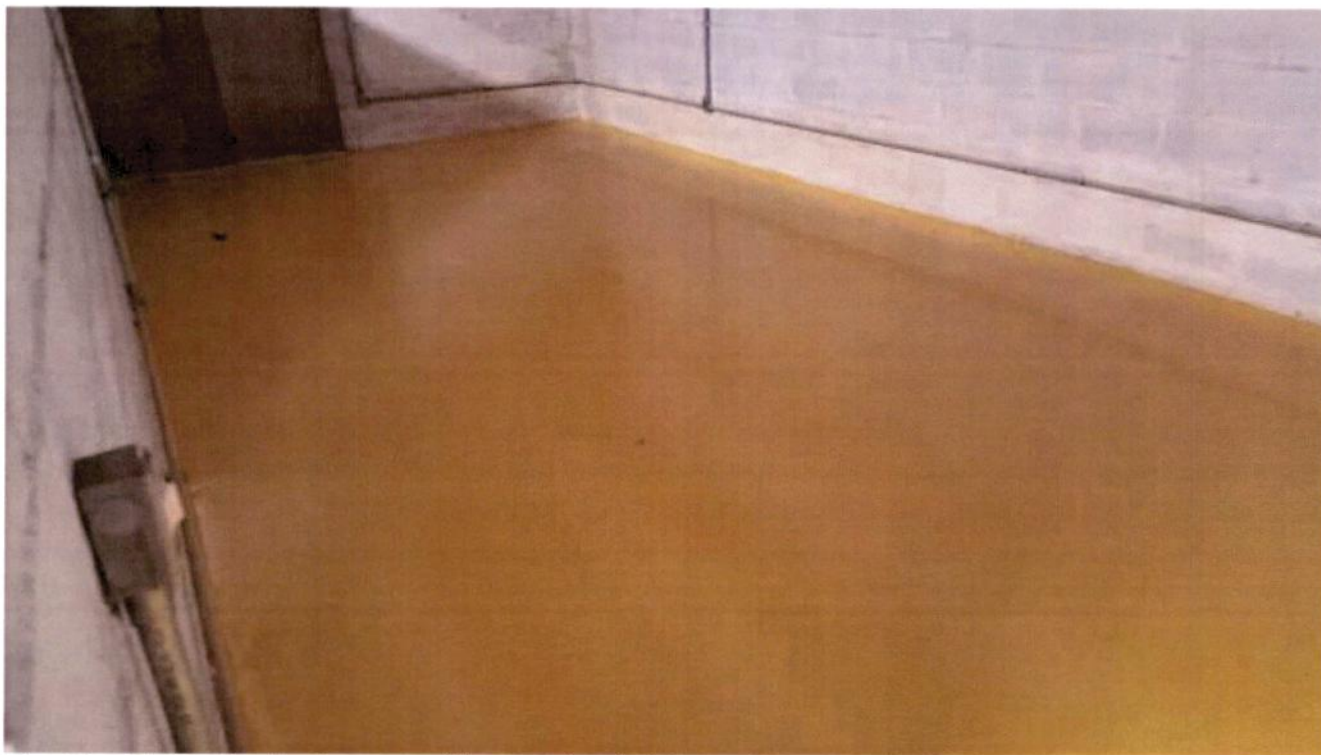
Execução do piso monolítico nos locais informados em projeto.
